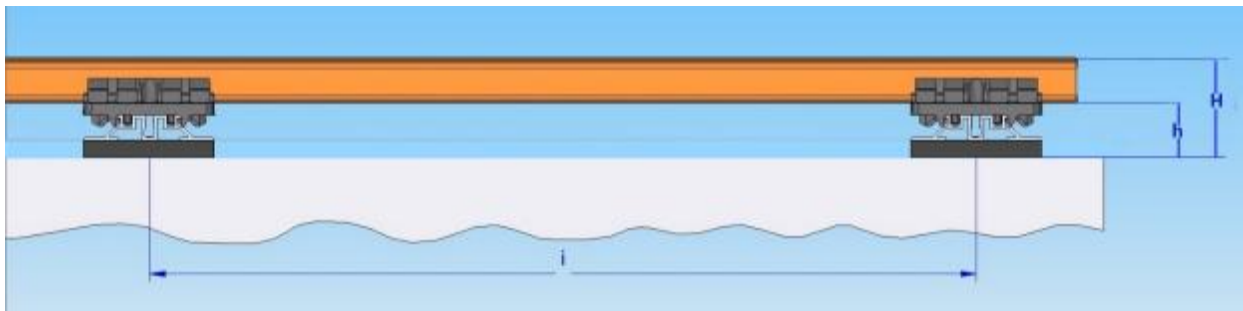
sezione longitudinale dei listoni in legno fissati su sottostruttura in alluminio KIT 50 ad altezza fissa
